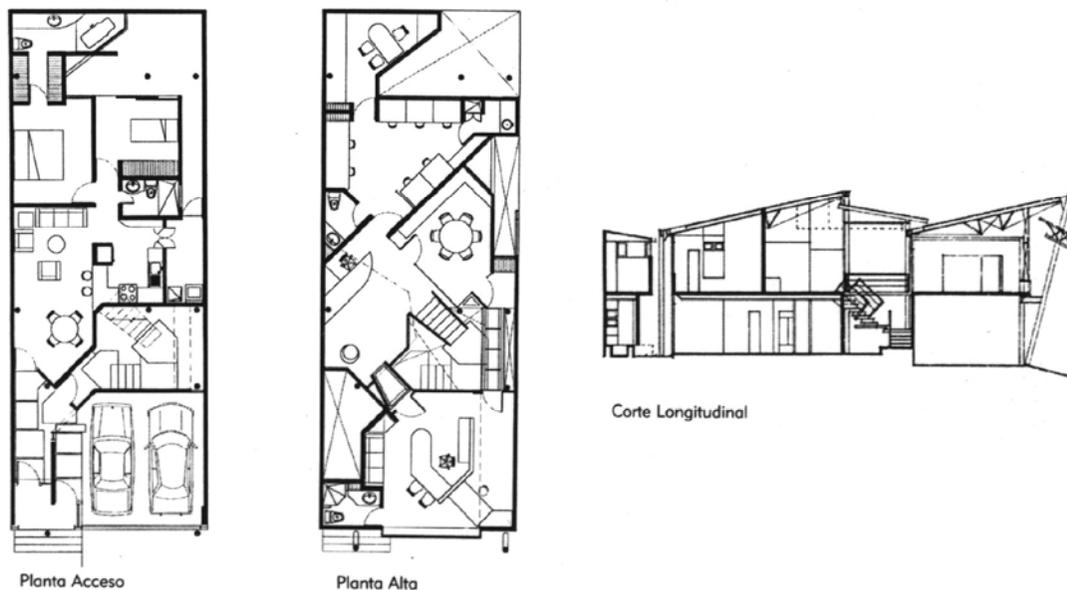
Planta de acceso, planta alta y corte longitudinal del edificio Elmizú.
